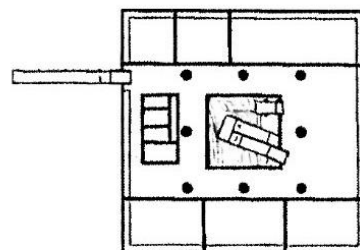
Additional cabins, Barbian Dreikirchen, Italy, проект 2007, эскиз плана и фасада
